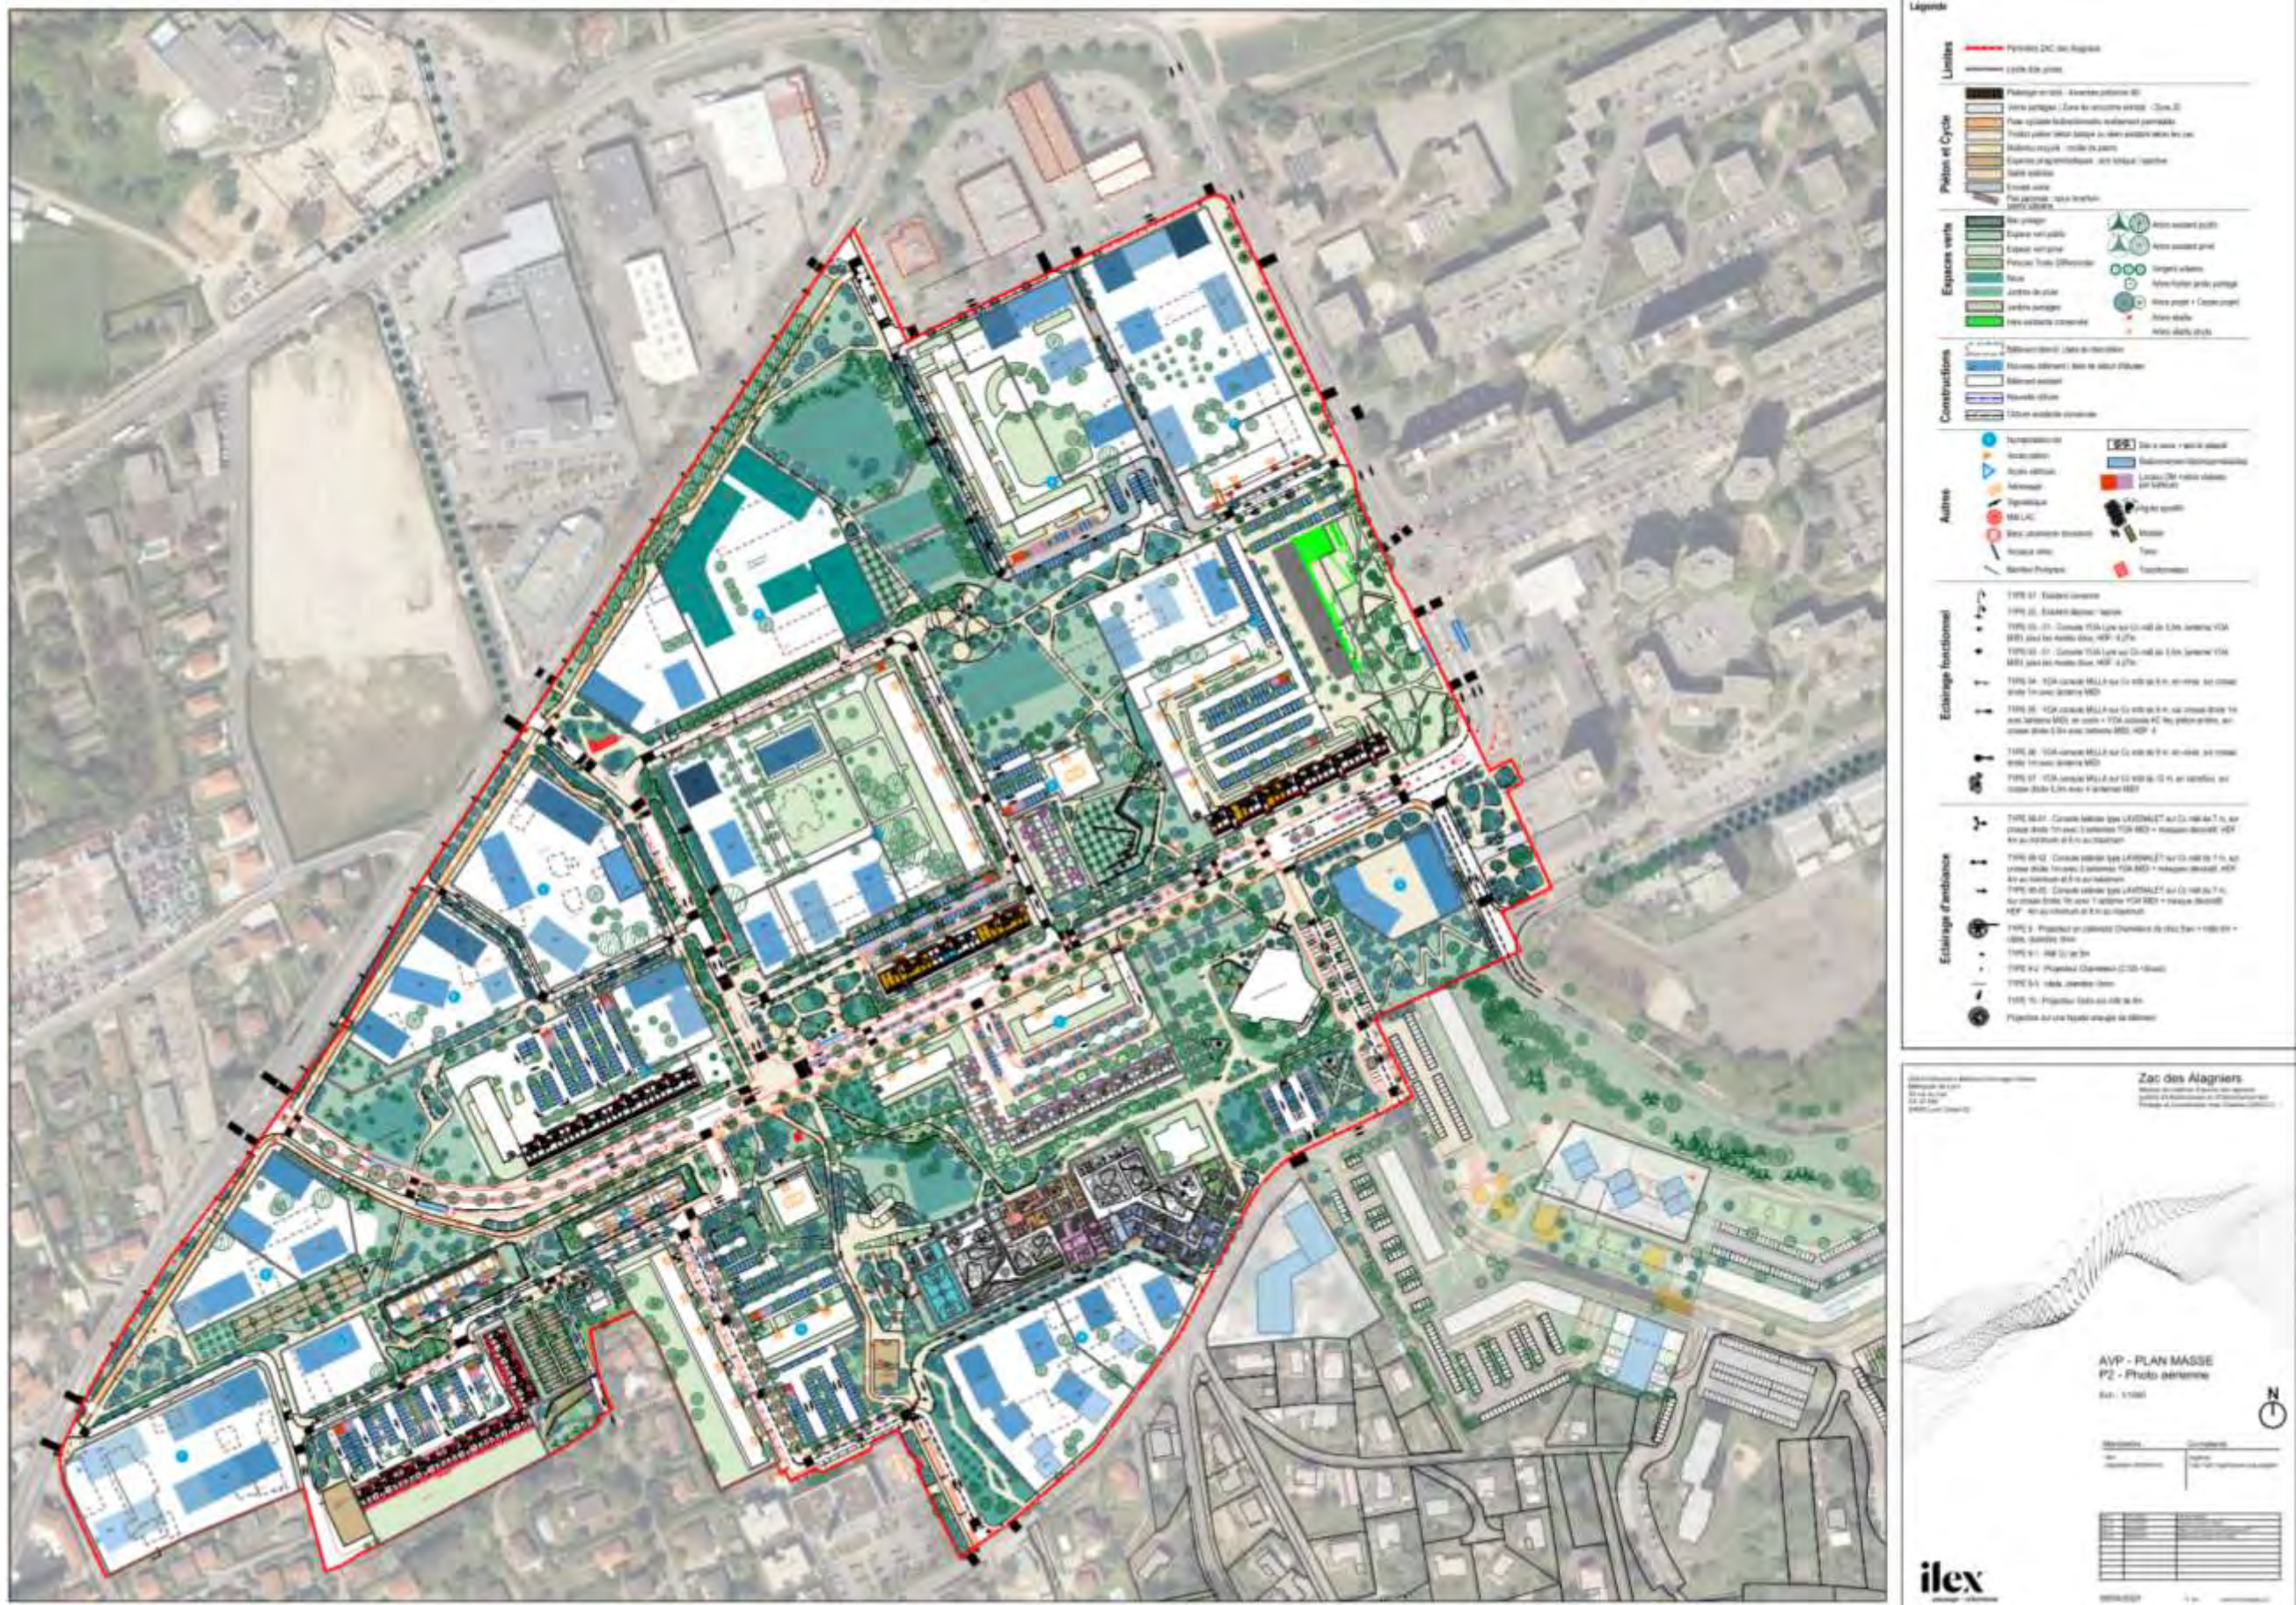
Plan masse du projet (Source : AVP Ilex)
